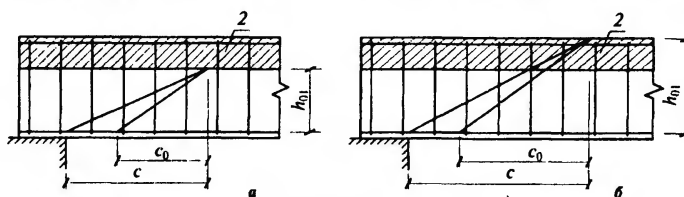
Расположение наклонных сечений при схеме расчета: *a* – по рабочей высоте усиливаемой конструкции; *b* – по рабочей высоте усиленной конструкции; 1 – усиливаемая конструкция; 2 – бетон усиления
